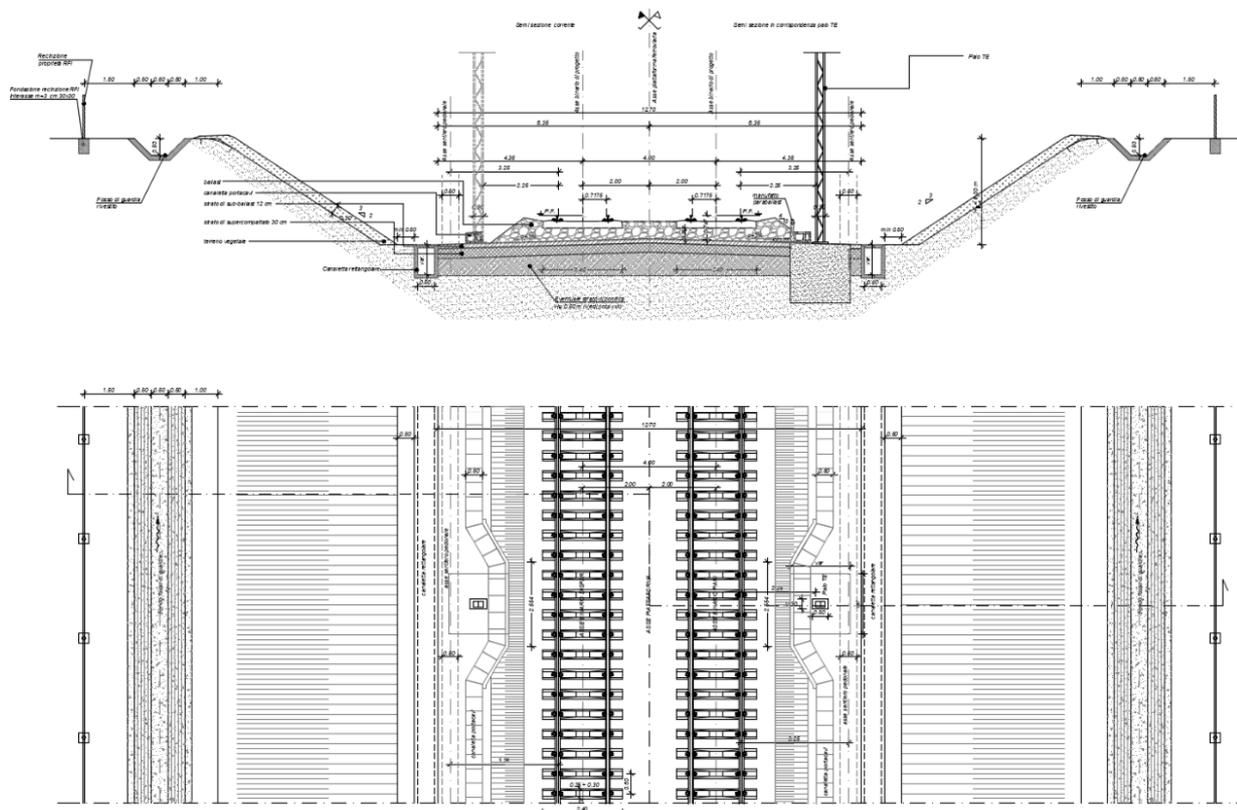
Sezione ferroviaria in trincea a doppia linea
